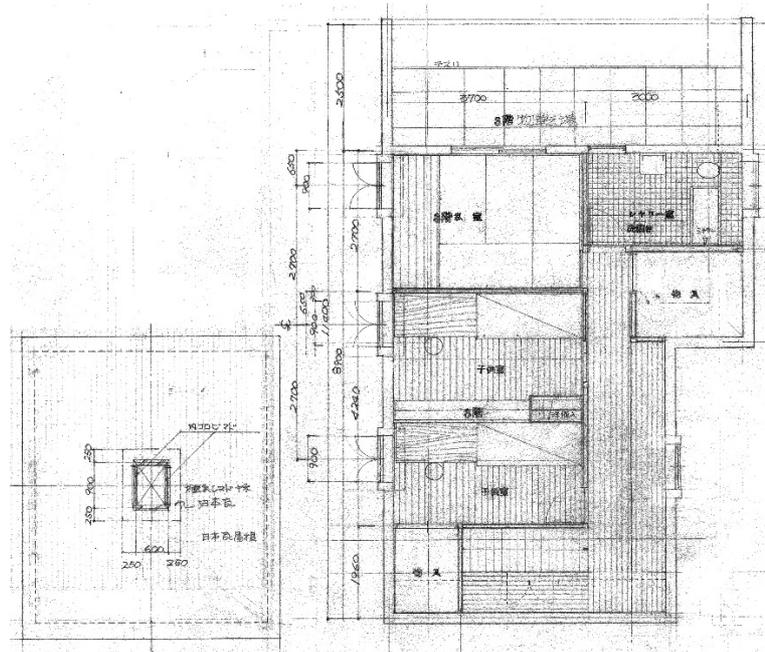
「水野レストラン」B棟屋根伏図・A棟3階平面図
